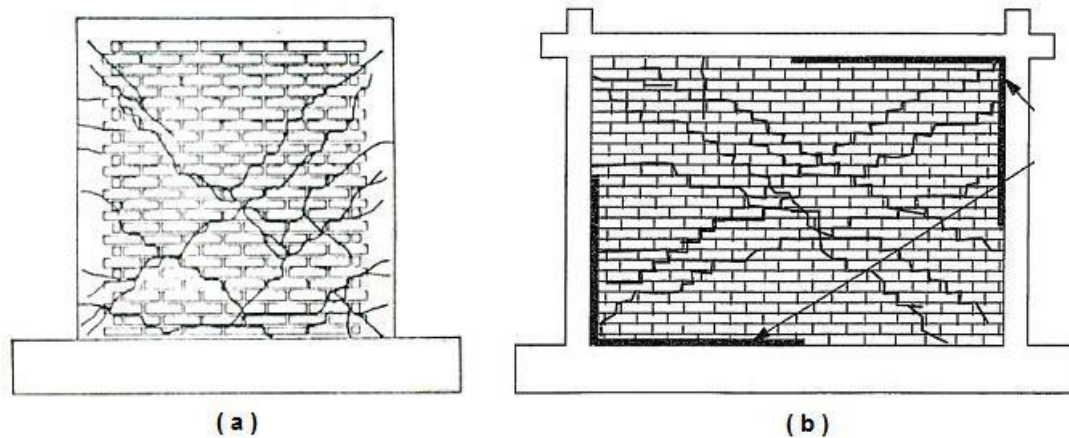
(a) Patrón de agrietamiento en estado último de muro de albañilería confinada (Diez, 1987), (b) Patrón de agrietamiento en estado último de un “infill wall” (Haider, 1995)
